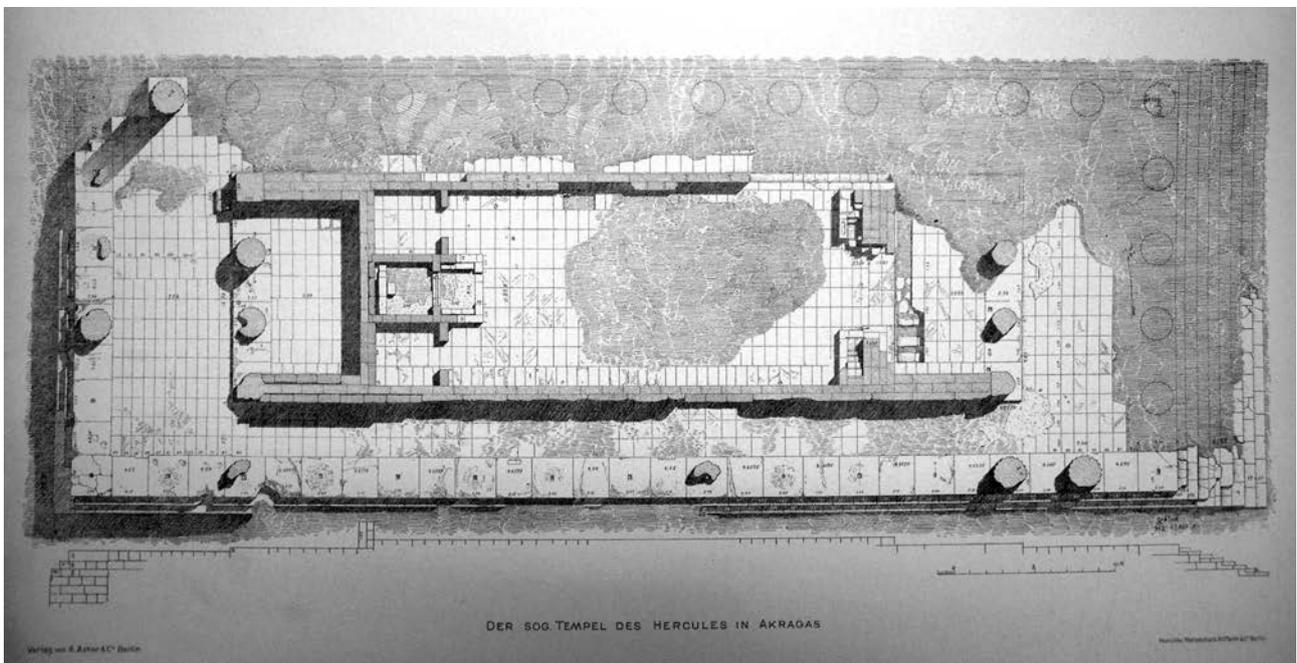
Pianta del Tempio A secondo Serradifalco.
